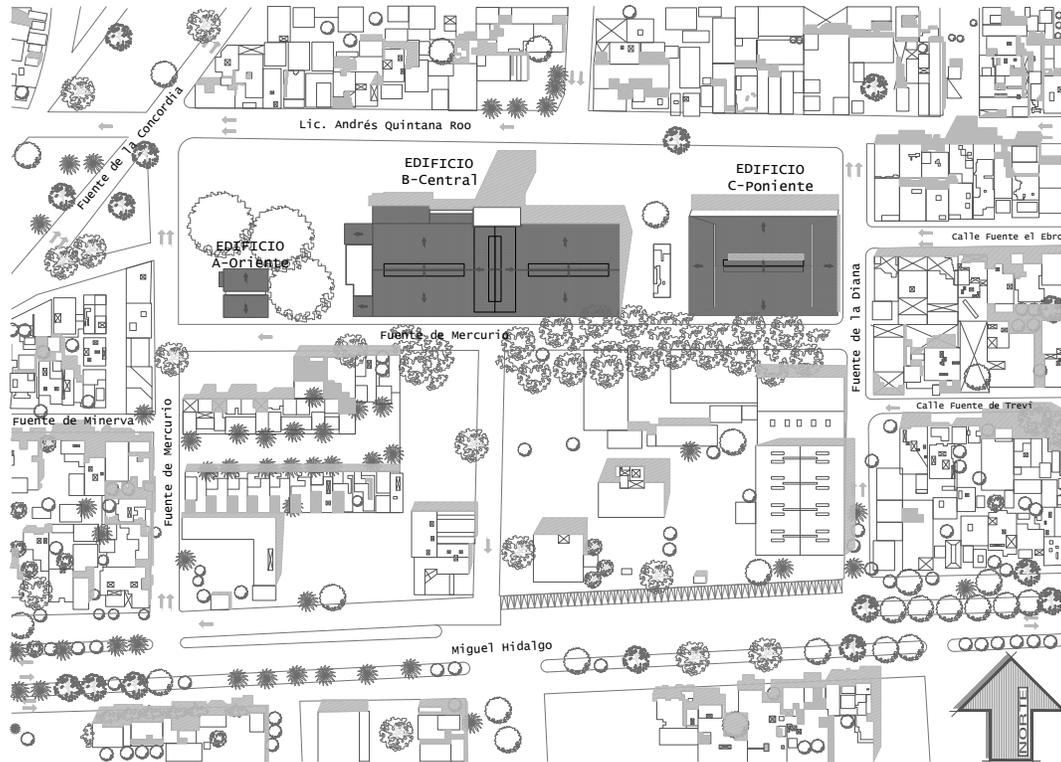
Planta del conjunto arquitectónico el Buen Tono, Celaya, Guanajuato
